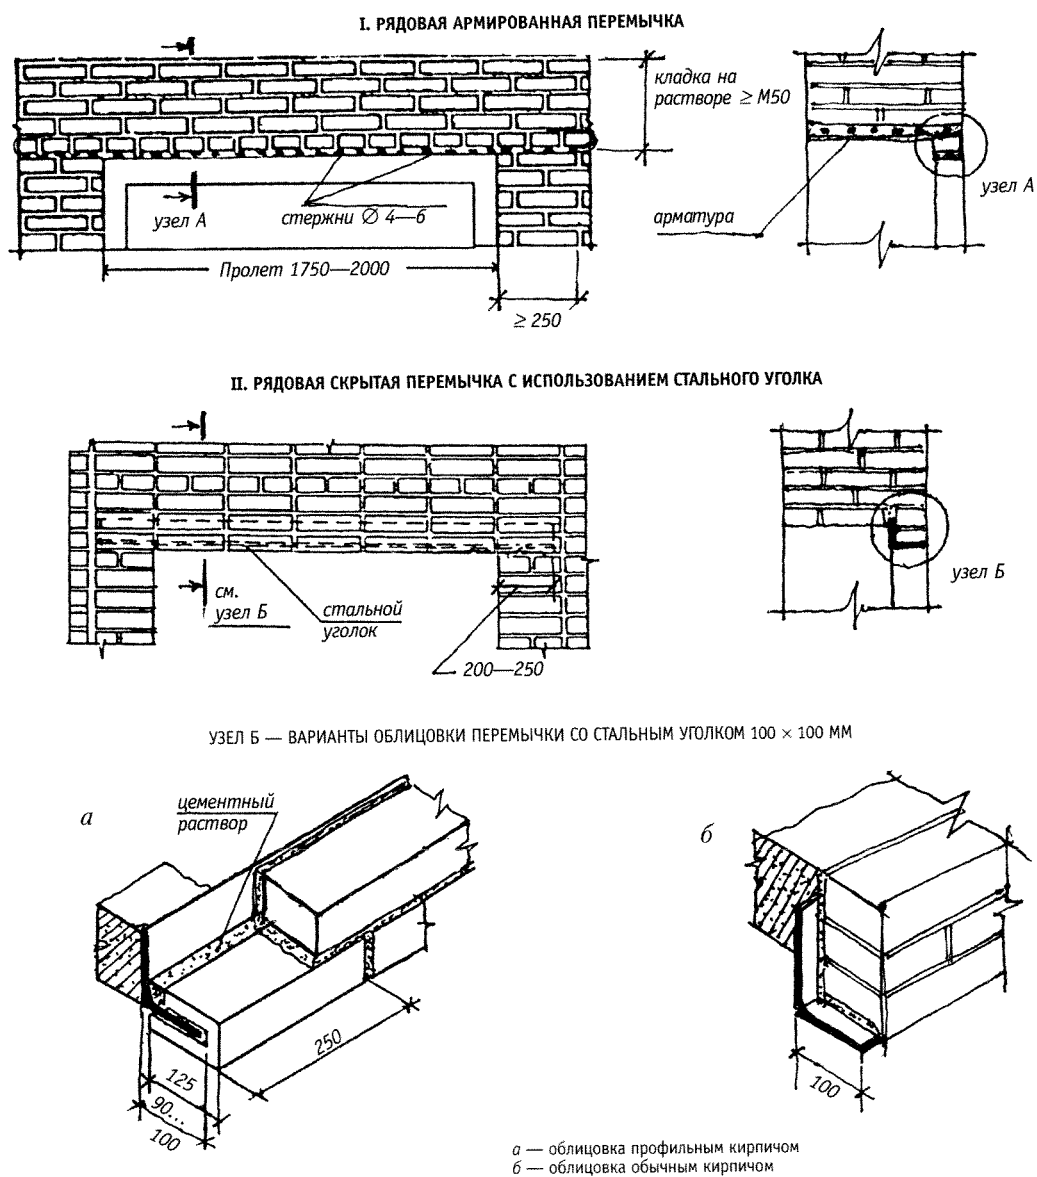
Рядовые перемычки, не нарушающие внешний облик и фактуру фасадов
